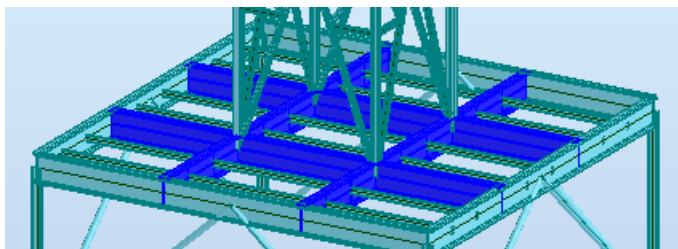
Barras das vigas principais da estrutura metálica de suporte
